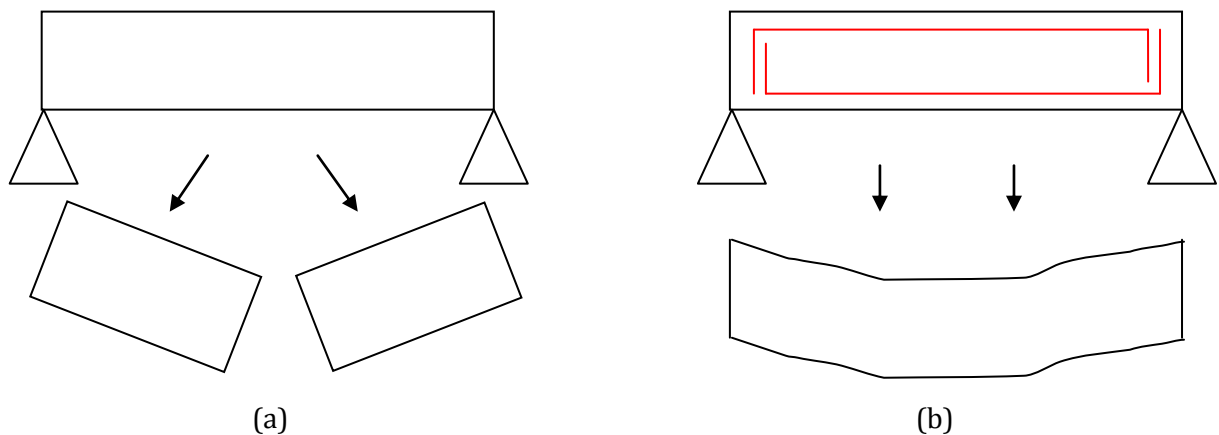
Déformation d'une poutre. (a) Déformation d'une poutre en béton sans armatures ; (b) Déformation d'une poutre en béton avec armatures. [10]
